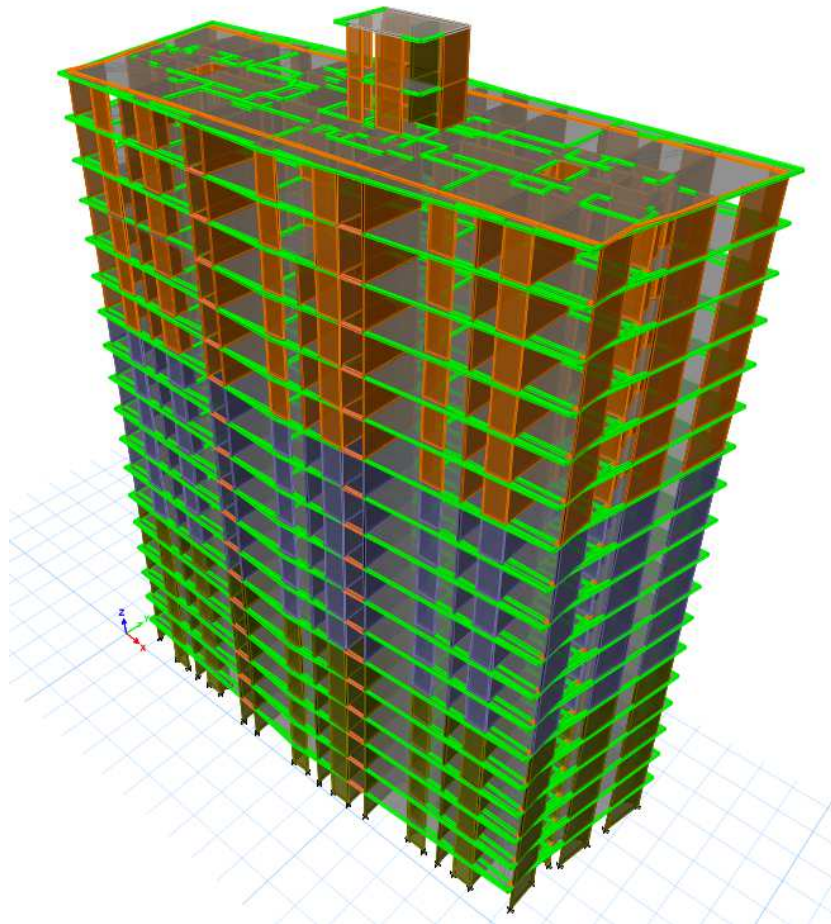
Vista isométrica modelo estructural Torre. Fuente: Elaboración propia.
